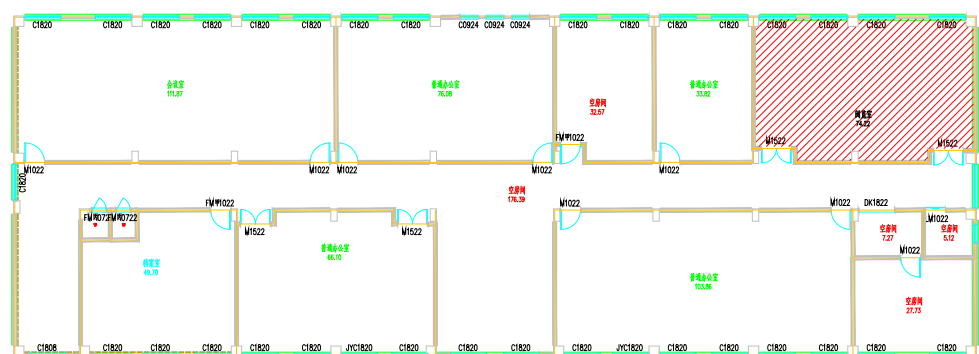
受建筑外部噪声影响的典型房间楼层平面图
